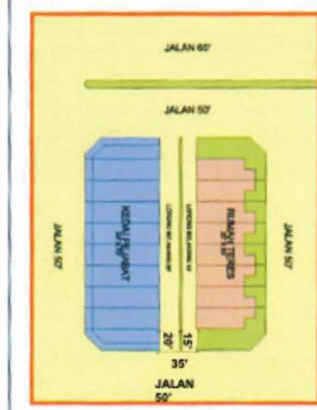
(iii) Perimeter Planting dalam Pembangunan Skim Strata
